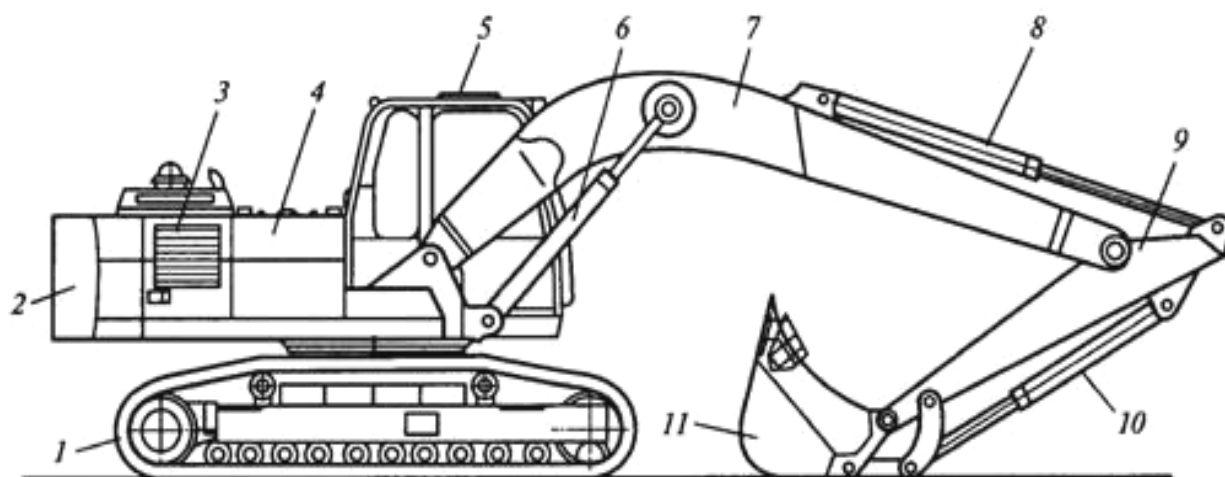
Одноковшовый полноповоротный гусеничный экскаватор ЕТ-18: 1 – гусеничное ходовое устройство; 2 – противовес; 3 – силовая установка; 4 – поворотная платформа; 5 – кабина оператора; 6, 8, 10 – гидродомкраты стрелы, рукояти и ковша; 7 – стрела; 9 – рукоять; 11 – ковш
